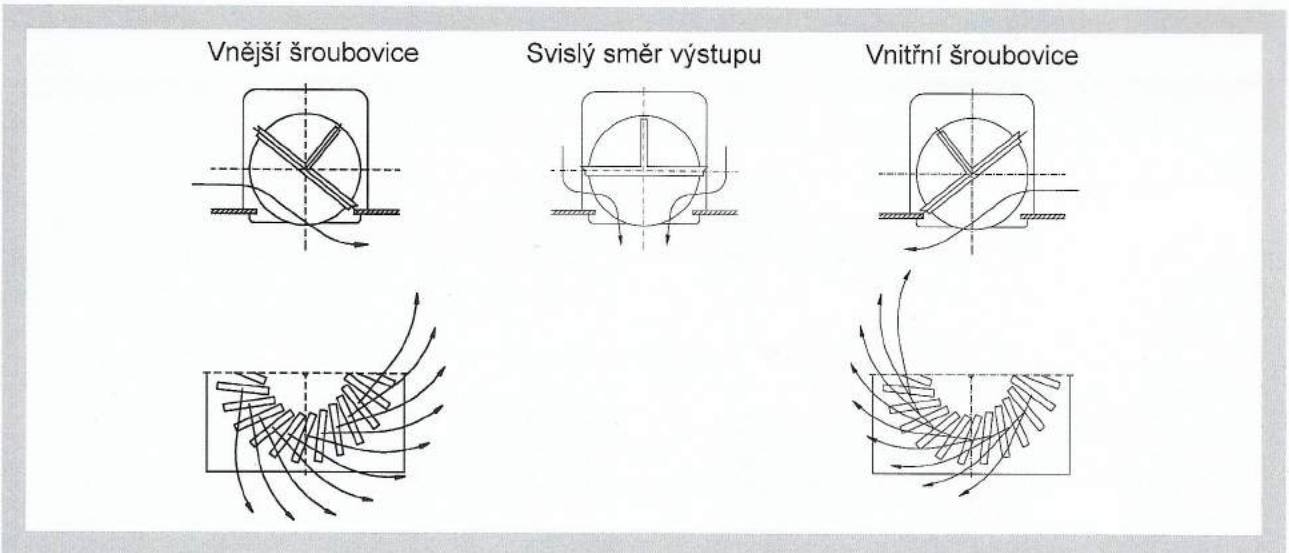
Provedení VVM/K - Čelní deska kruhová
